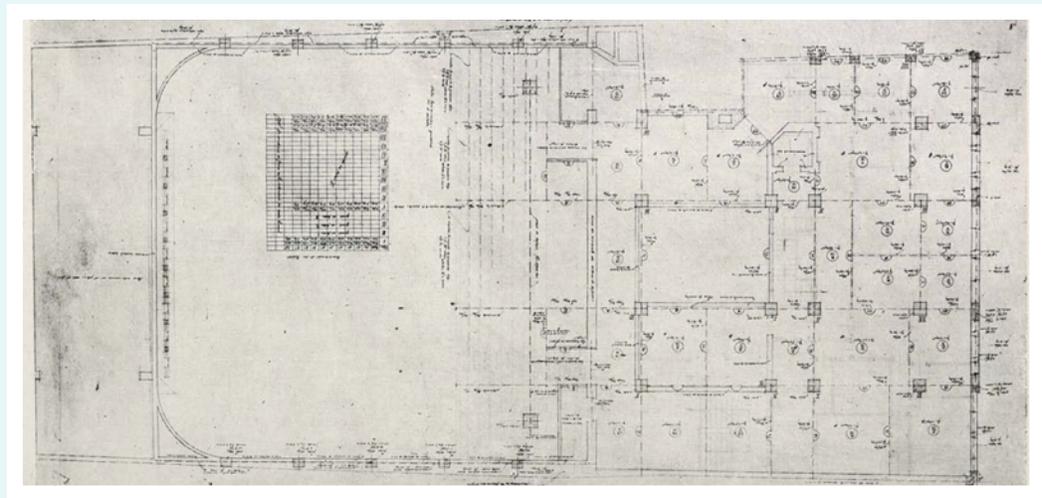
Teatro Real, Platea Alta / Paraíso. Estructuras de Hormigón y Armaduras. Fuente: *Arquitectura y Arte Decorativo*, n.º 2, (septiembre de 1931): 66-74.
